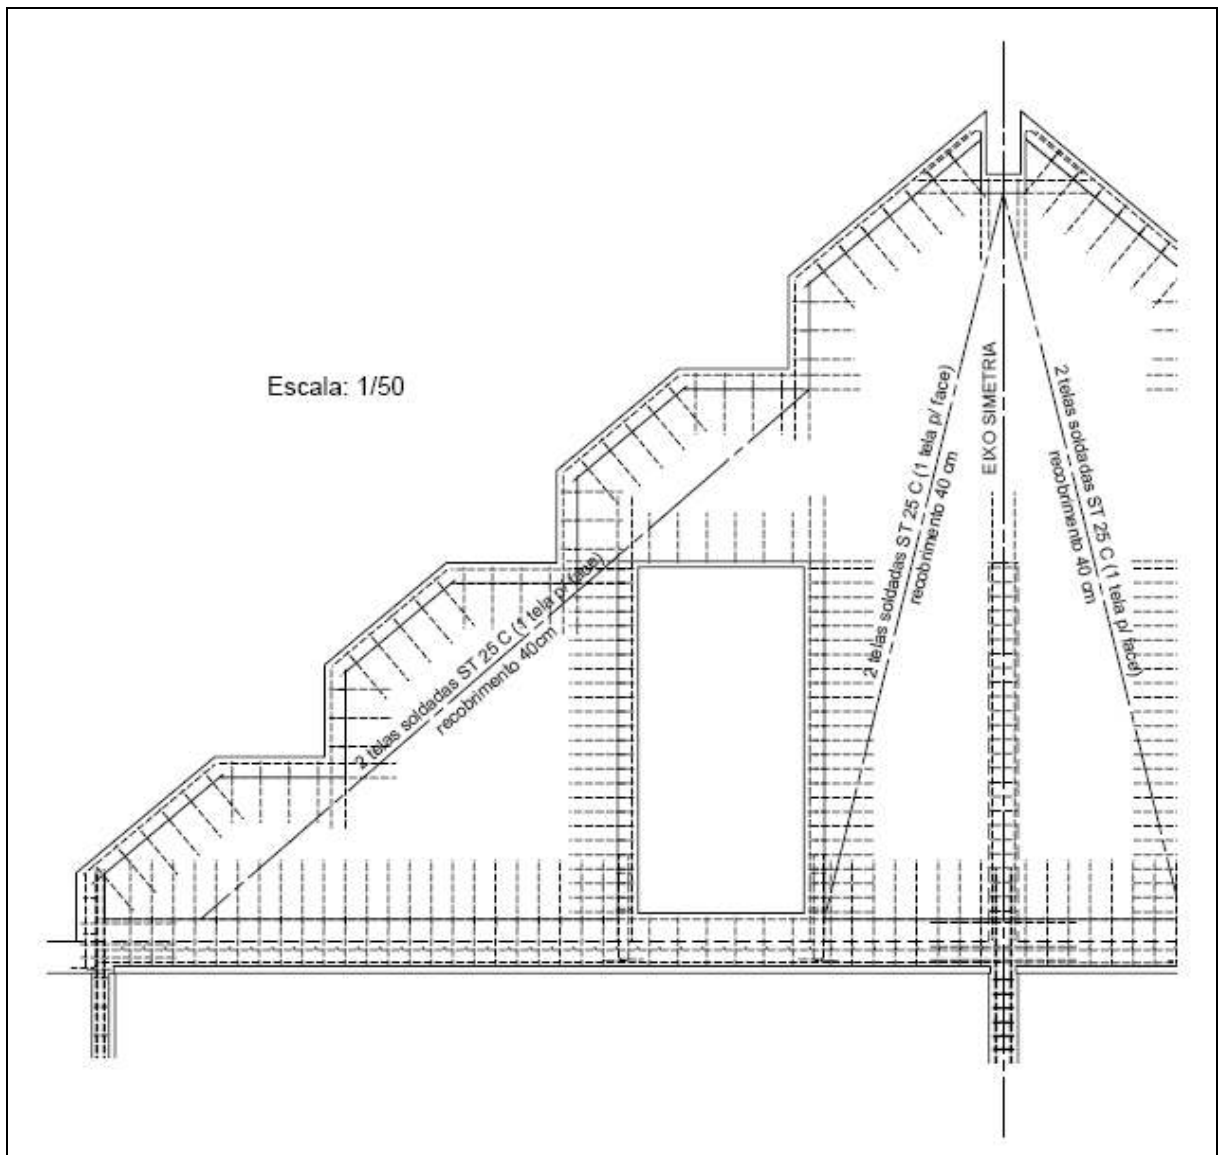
armaduras no formato de telas soldadas do tipo ST 25 C
